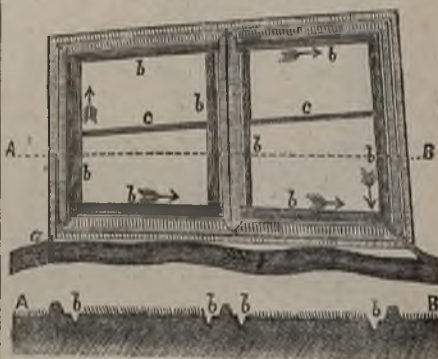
Irygacja: rysunek górny — plan pola, irygowanego przez zalow; rys. dolny — jego przekrój po linii A B.
